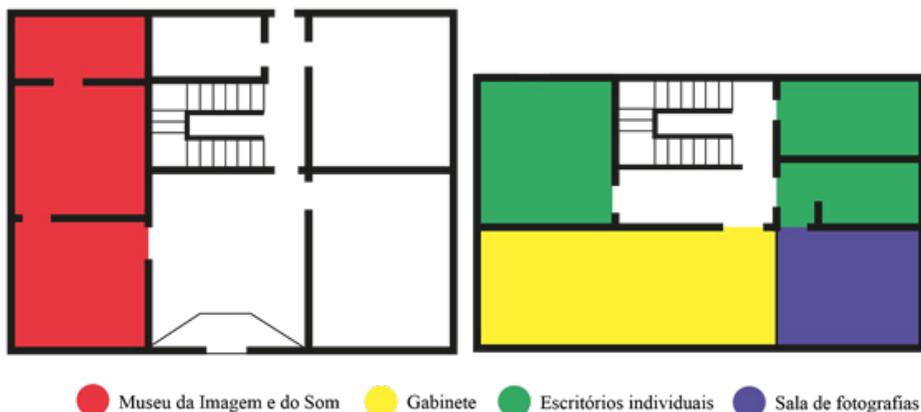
Esquema da planta térrea com demarcação das áreas de exposição do museu. Fonte: Autor, 2021.
